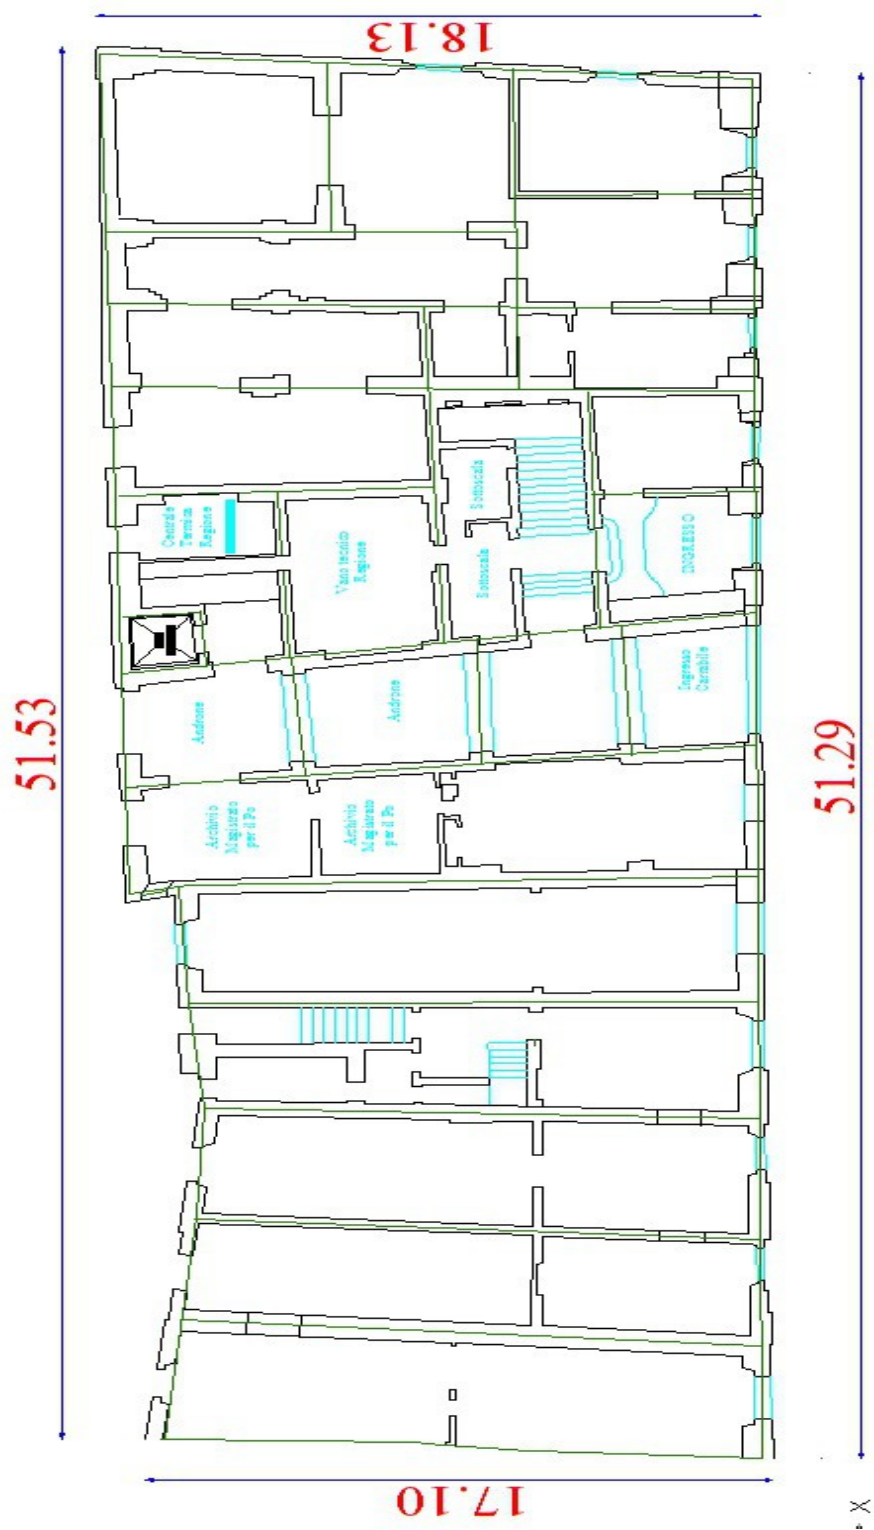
Planimetria piano primo H.4,30 – (disegno fuori scala)
